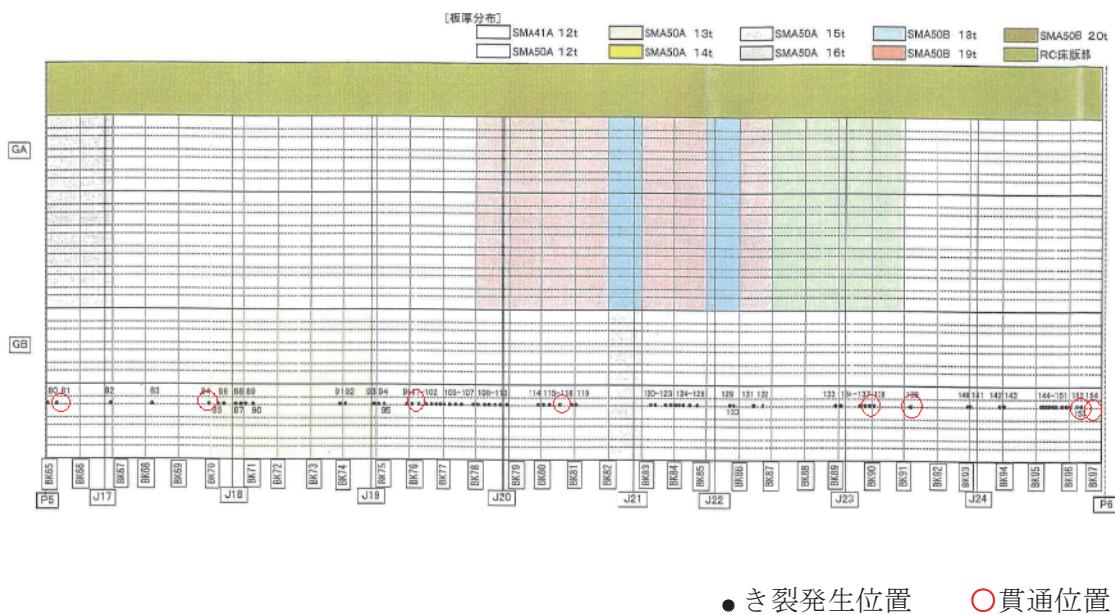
(a) き裂発生位置 (平面図の一例 P5~P6)
